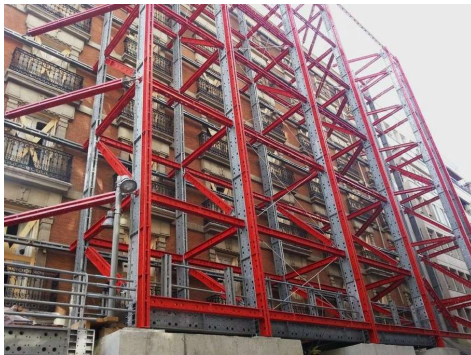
Otro ejemplo de estructura metálica de un estabilizador de fachada, esta vez solucionado con perfilaría metálica.
